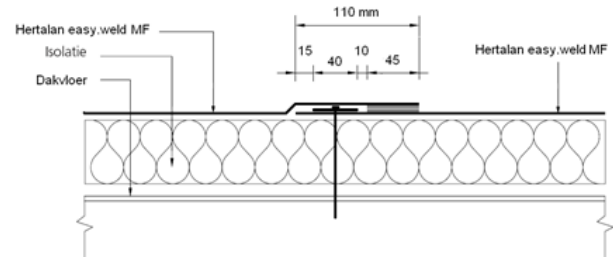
Langse overlapverbinding HERTALAN EASY WELD MF
